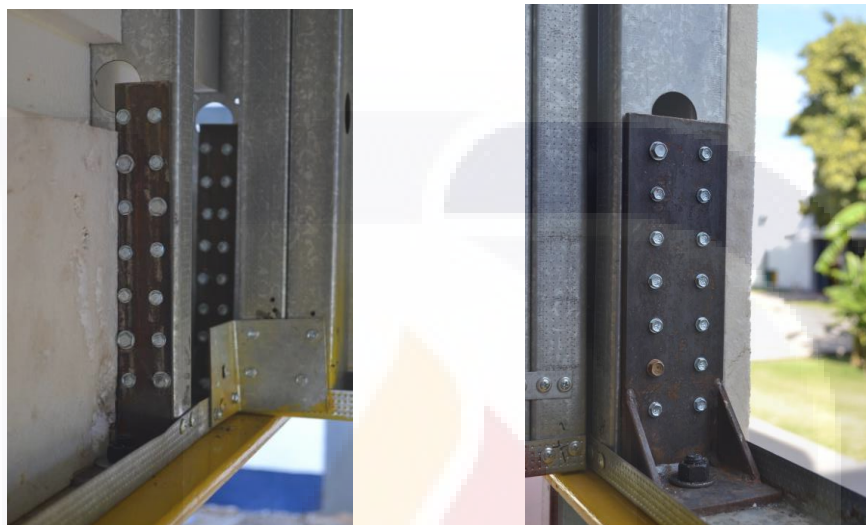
Anclajes tipo Hold-Down en studs de muro norte.
